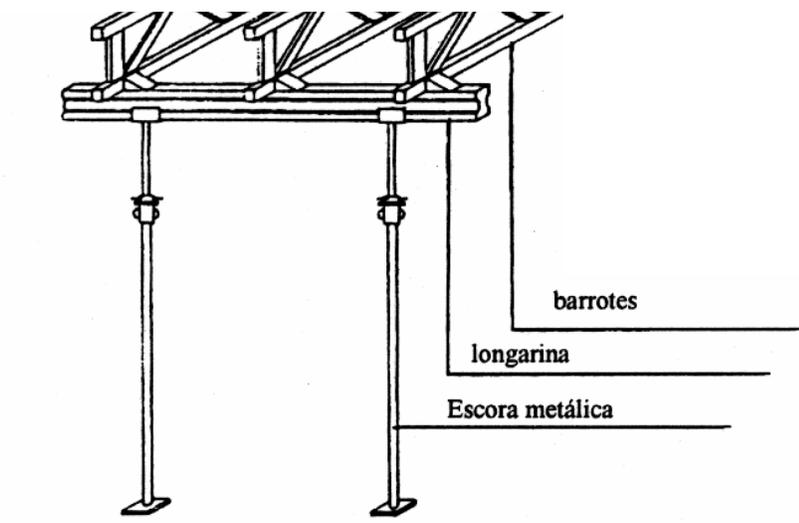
Exemplo de escoramento metálico para laje pré-fabricada
